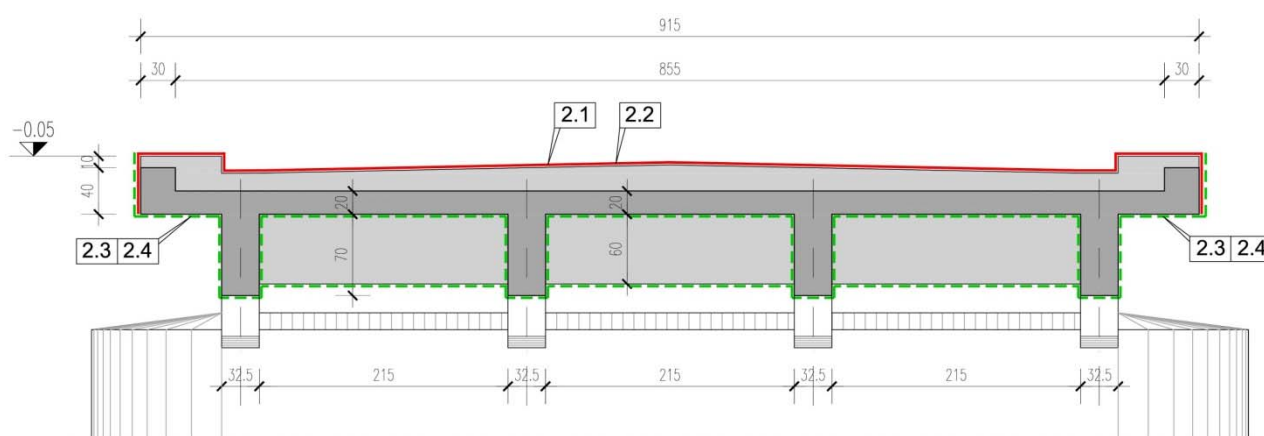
Sezione tipologica impalcato - fase di impermeabilizzazione
